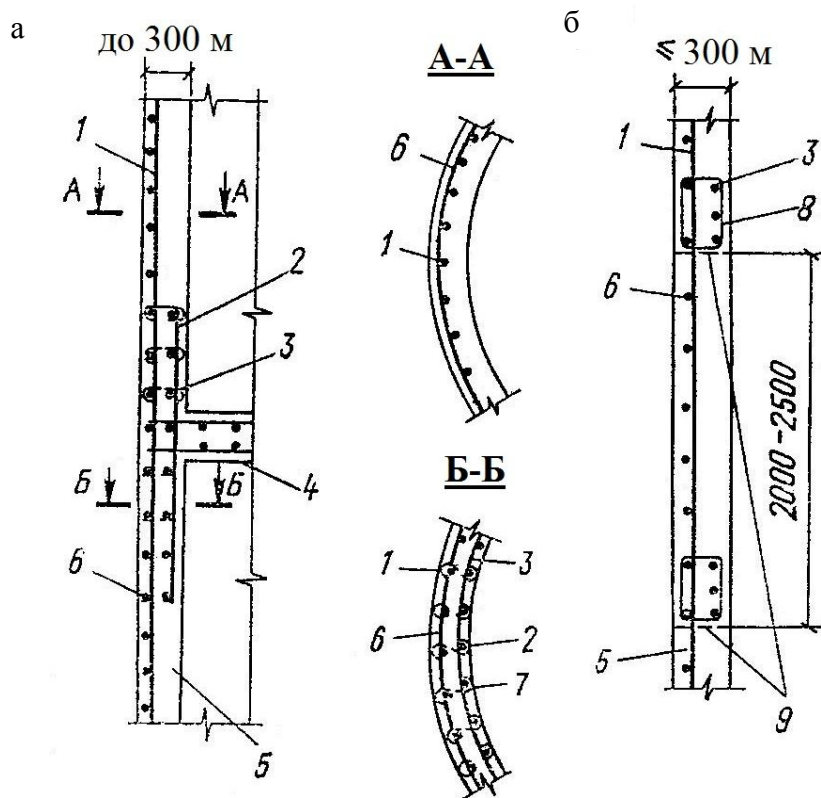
Детали армирования стенки ствола башни:
